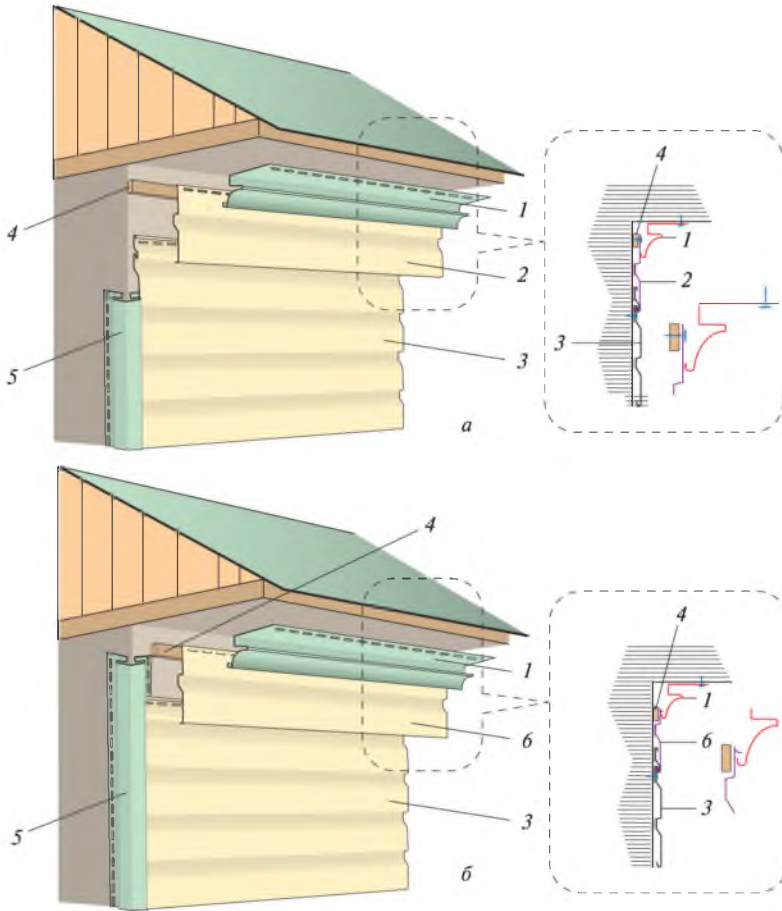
Схема монтажа сайдинга прикрываемых молдингом Дёске: а — на крепежах; б — на зацепах; 1 — молдинг Дёске; 2 — подкарнизный сайдинг с дополнительными гвоздевыми отверстиями; 3 — рядовой сайдинг; 4 — выравнивающая рейка; 5 — угловой сайдинг; 6 — подкарнизный сайдинг с «зацепами»
